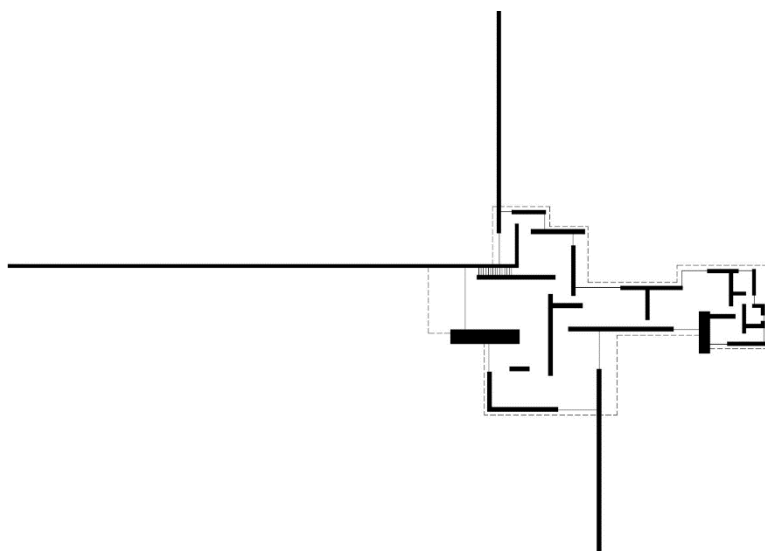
Planta Baja del Proyecto de la Casa de Campo de Ladrillo, Postdam-Neubabelsberg, Mies van der Rohe, 1923.
